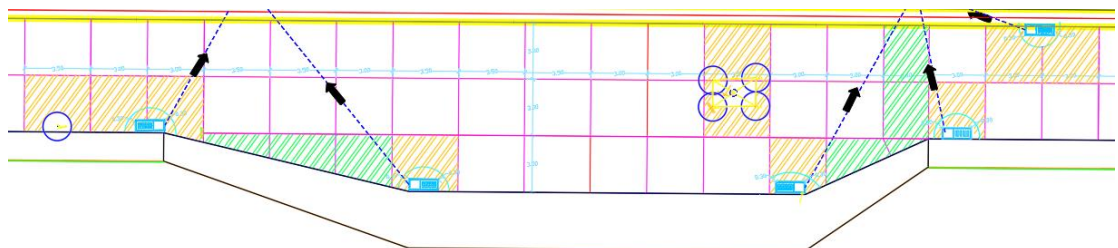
Pavimento fundido (azul) calzada sur tramo 7B.
